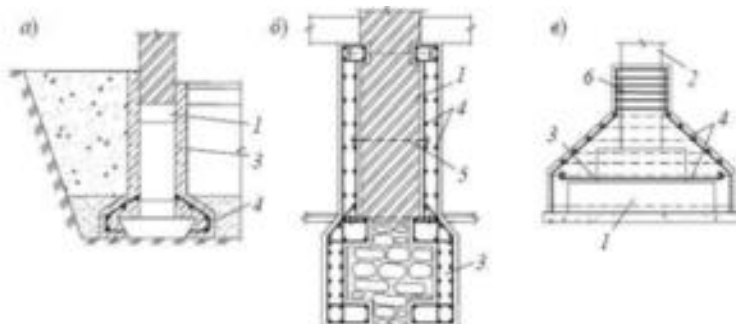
Усиление обоймами стен (а), (б) и столбов (в) подвала: 1 – стена подвала и фундамента; 2 – столб; 3 – обойма; 4 – арматурные стержни; 5 – арматурные тяжи; 6 – хомуты.
